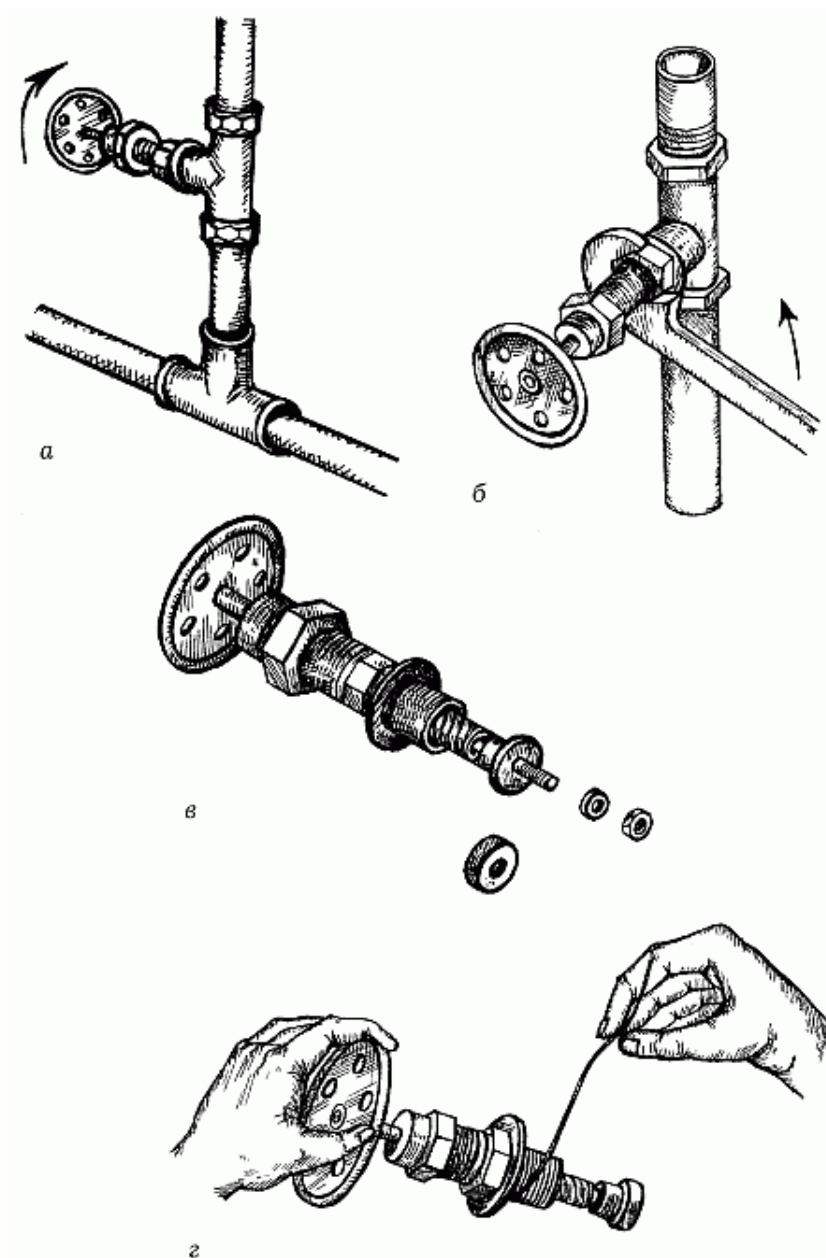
Замена прокладки в вентиле: а – перекрытие вентиля на трубопроводе; б – выворачивание части вентиля; в – замена резиновой прокладки; г – намотка пряди уплотнения
